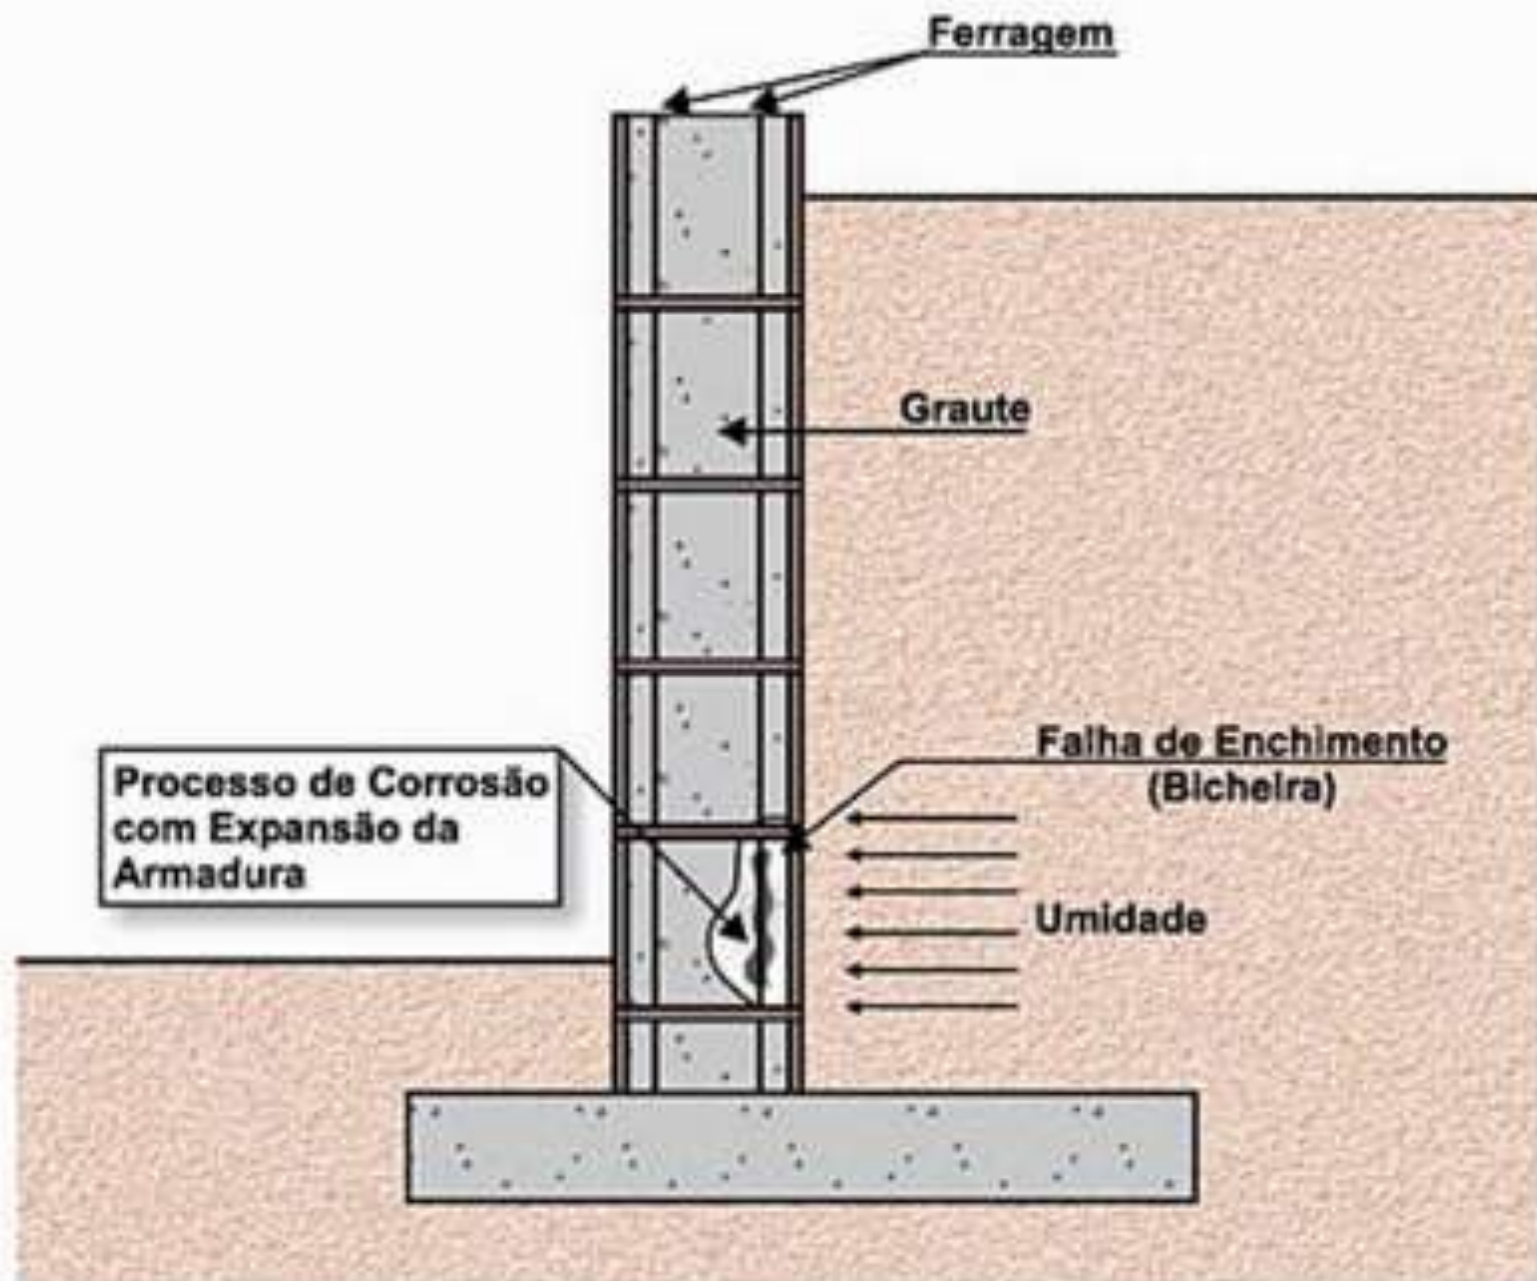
Muros de arrimo de alvenaria estrutural
